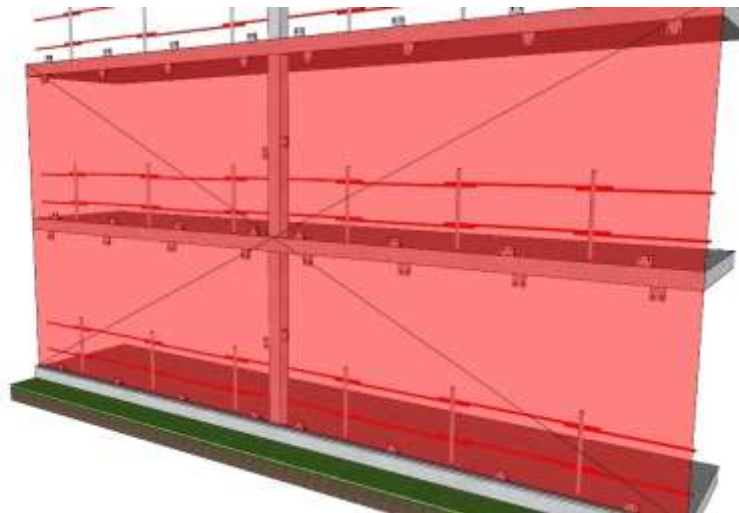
Réglage des équerres d'ancrage afin de dresser l'aplomb général de la façade (FP2)
